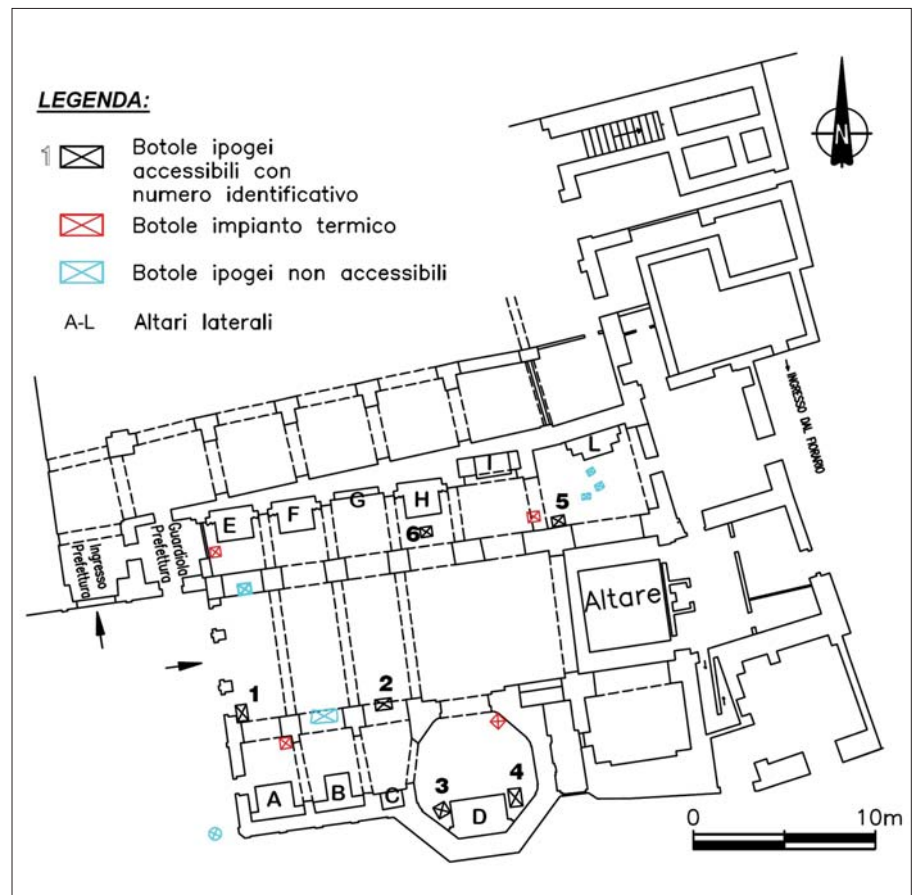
Planimetria della chiesa di San Domenico con ubicazione delle botole e degli altarini.
